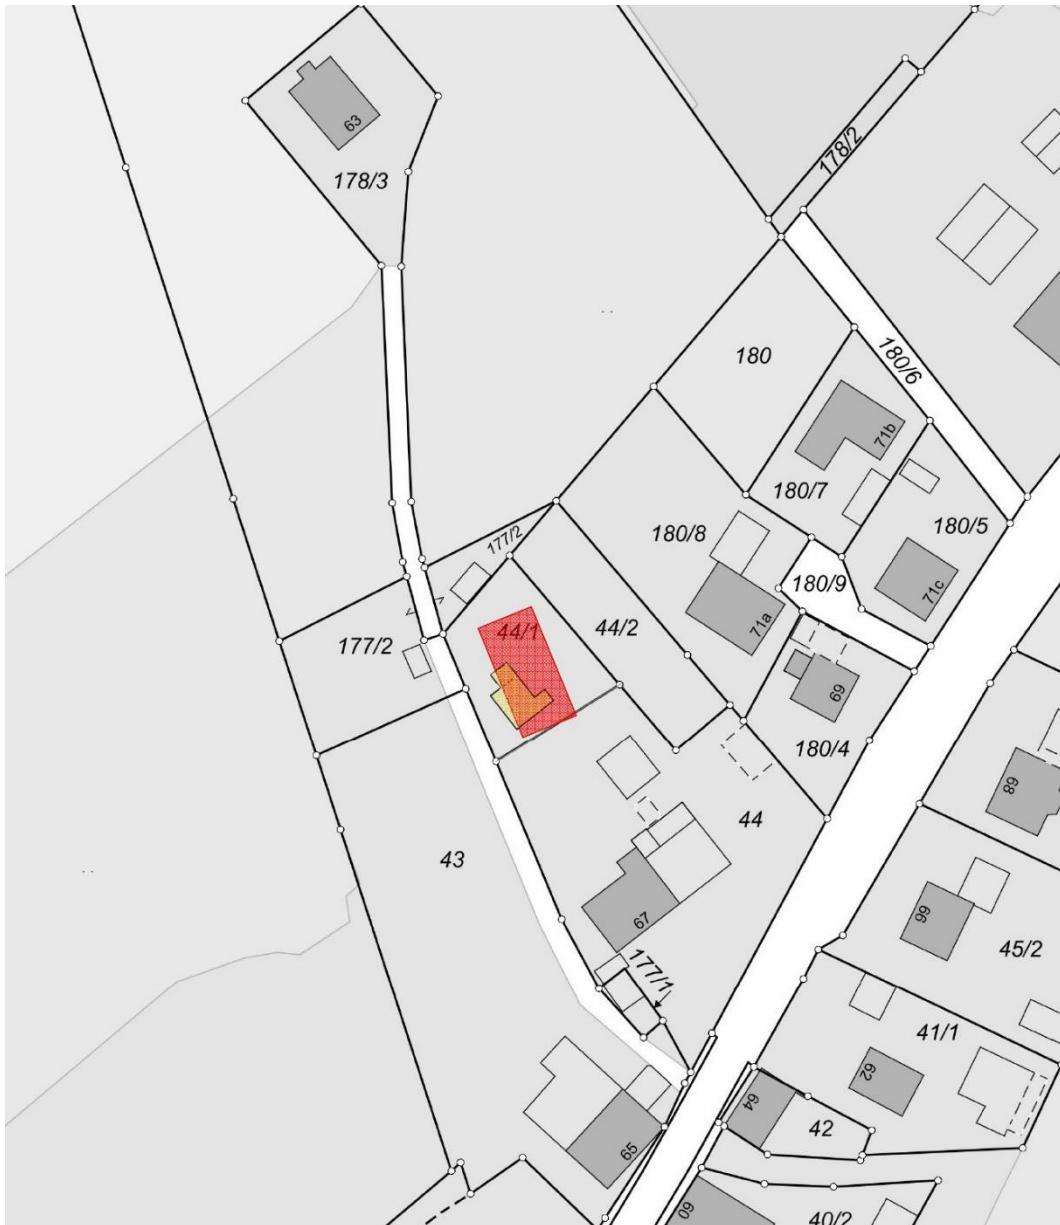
Lageplan aus der Bauvoranfrage vom 24.10.2024 (unmaßstäblich). Die Grundfläche des geplanten Neubaus ist rot markiert.
